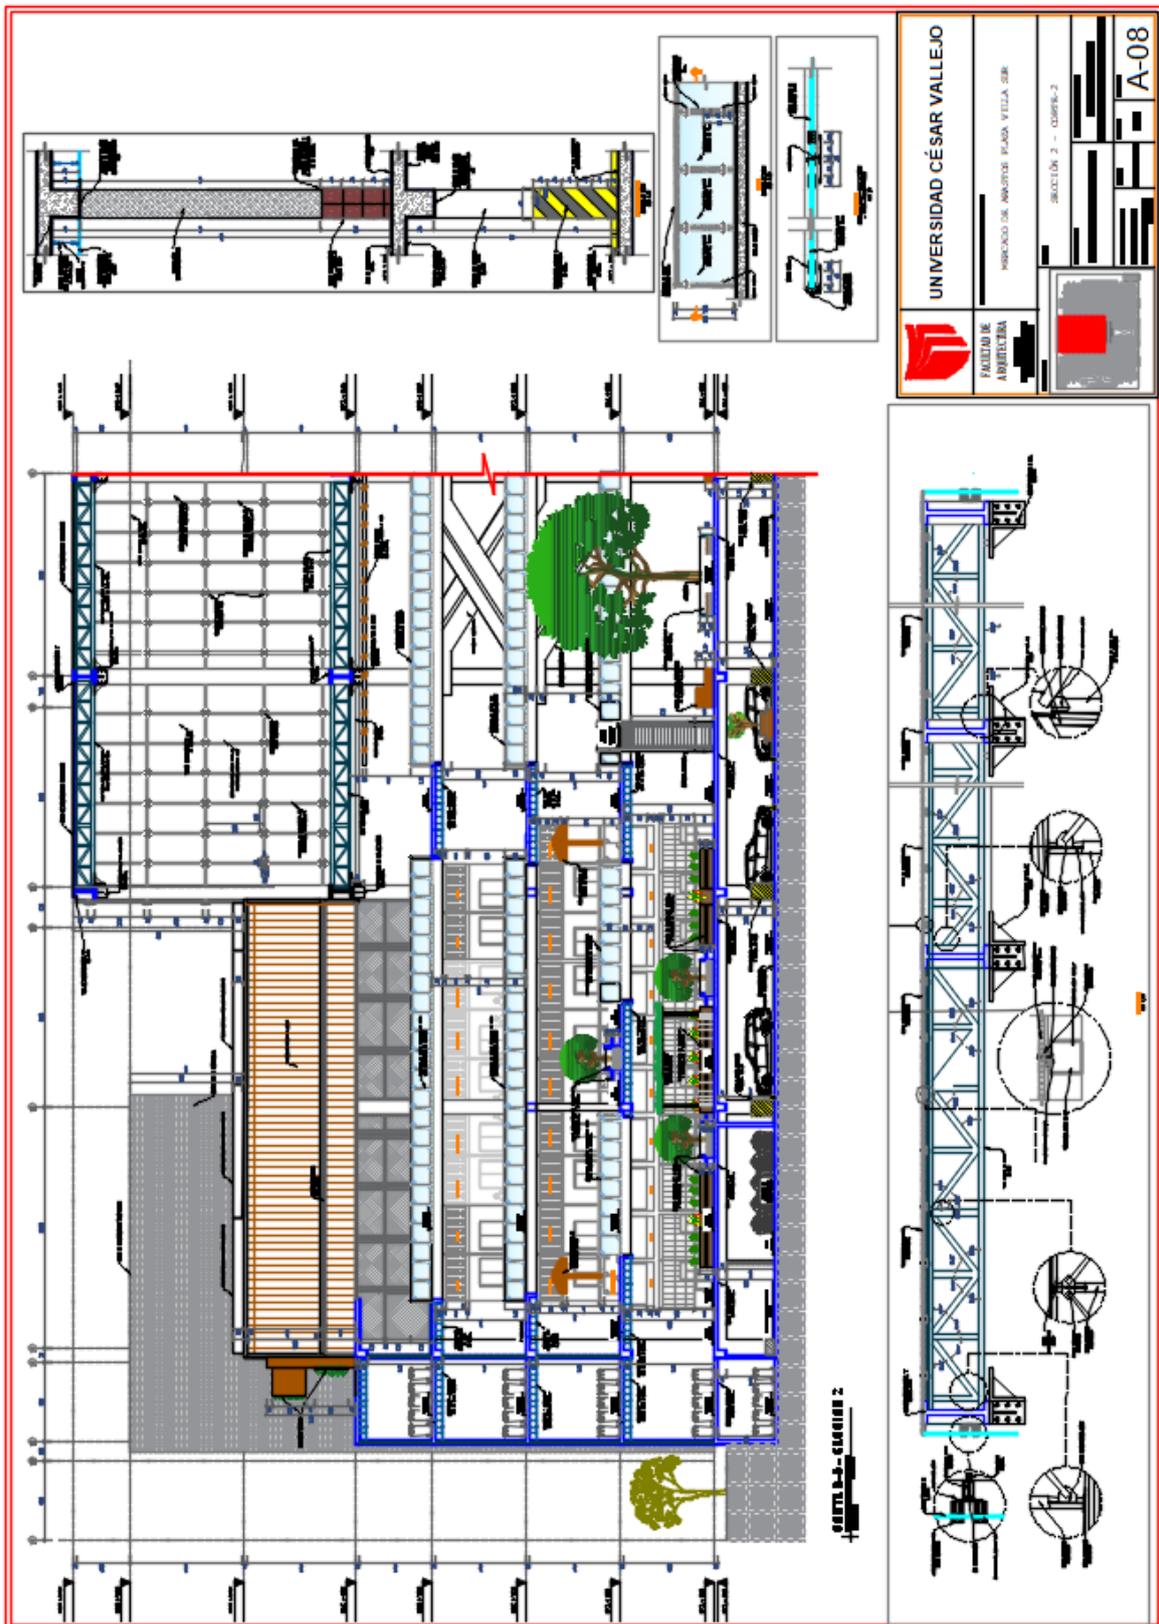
Plano de Arquitectura – Plano de secciones – plano de cortes
